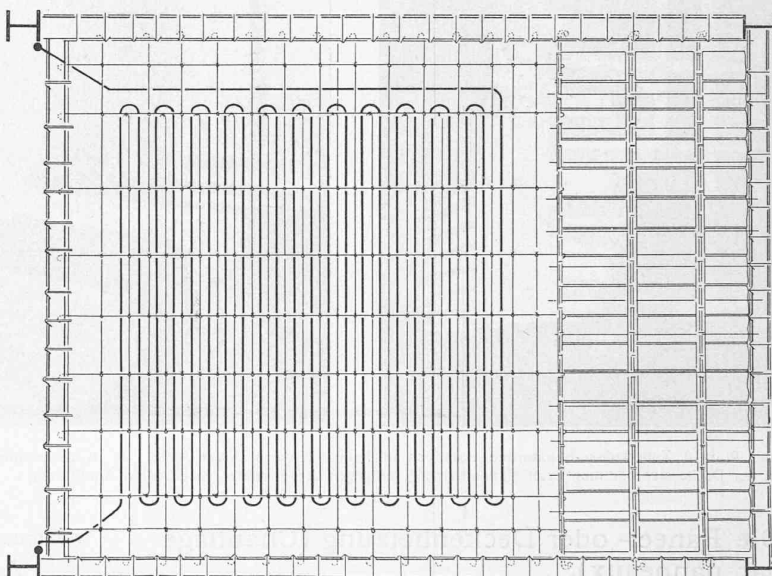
Grundriss einer Decke mit den Heizungsrohren. Ausführung Gebrüder Sulzer A.-G.
